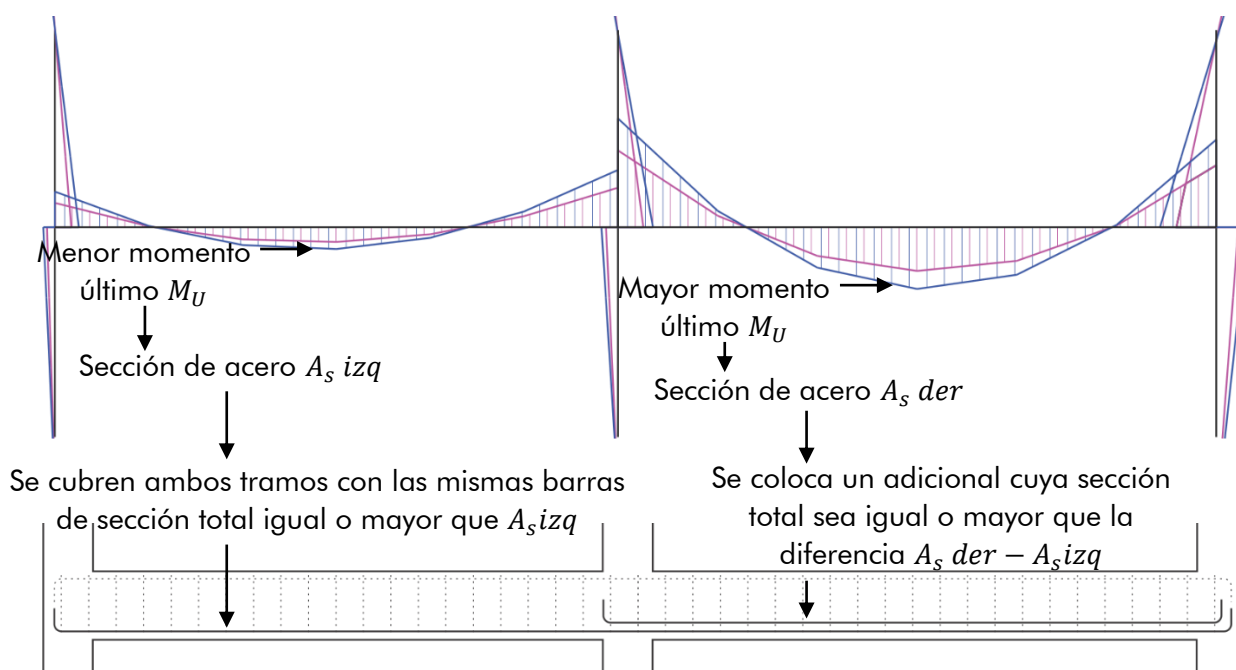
Armado inferior de viga de dos tramos con armadura suplementaria
